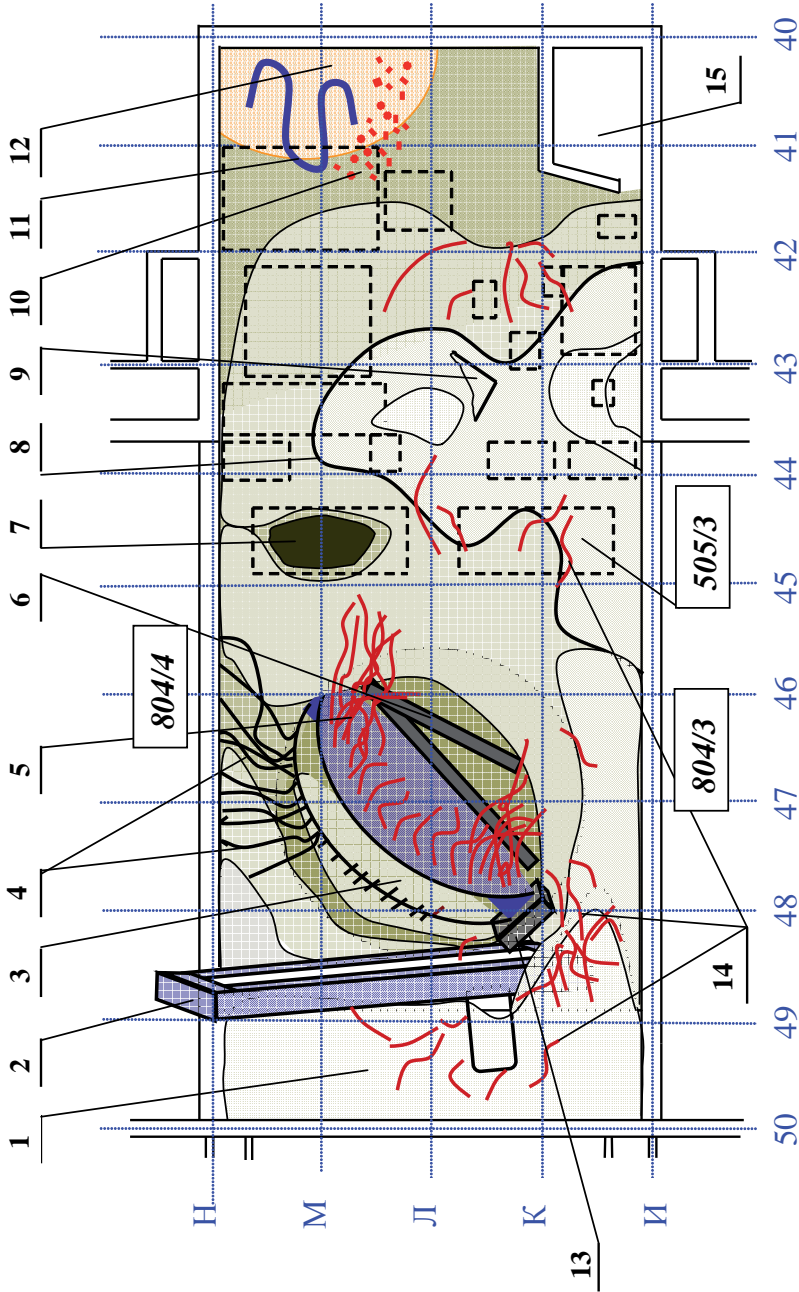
Схема ЦЗ после аварии. Обозначения: 1 – половая «терраса»; 2 – мост РЗМ; 3 – сх. «Е»; 4 – ПВК; 5 – смятые трубы; 6 – балки перекрытия; 7 – провал в пом. 504/4; 8 – насыпь; 9 – стальной лист; 10 – АЗФ, сброшенные с крыши; 11 – облицовка теплозащиты?; 12 – зона предполагаемого расположения кассет со свежим топливом; 13 – ж/б плита; 14 – ТВС и их фрагменты; 15 – пультовая
